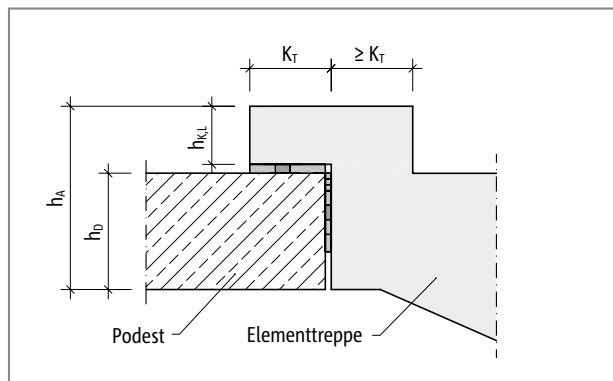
Schöck Tronsole® Typ BL: Bemessung
